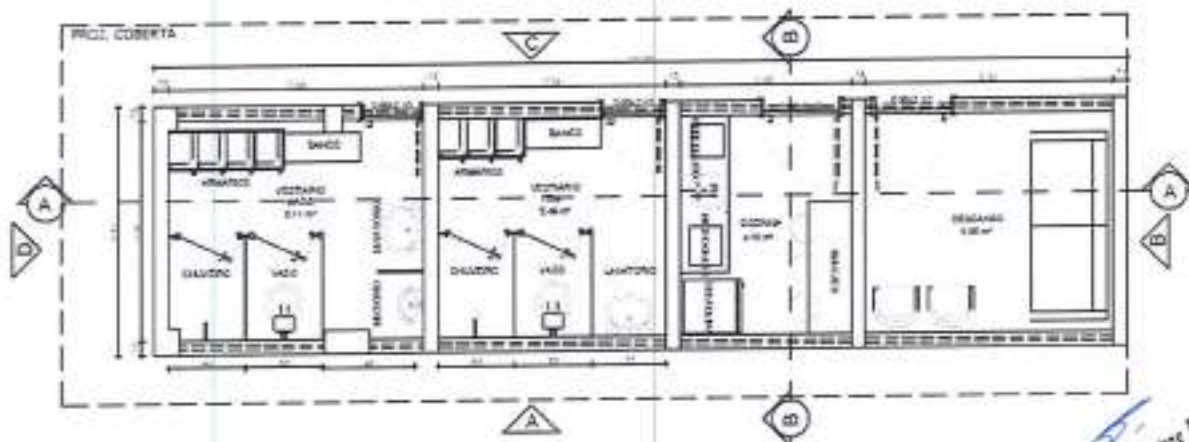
Planta Baixa – Edificação de apoio (sem escola)
